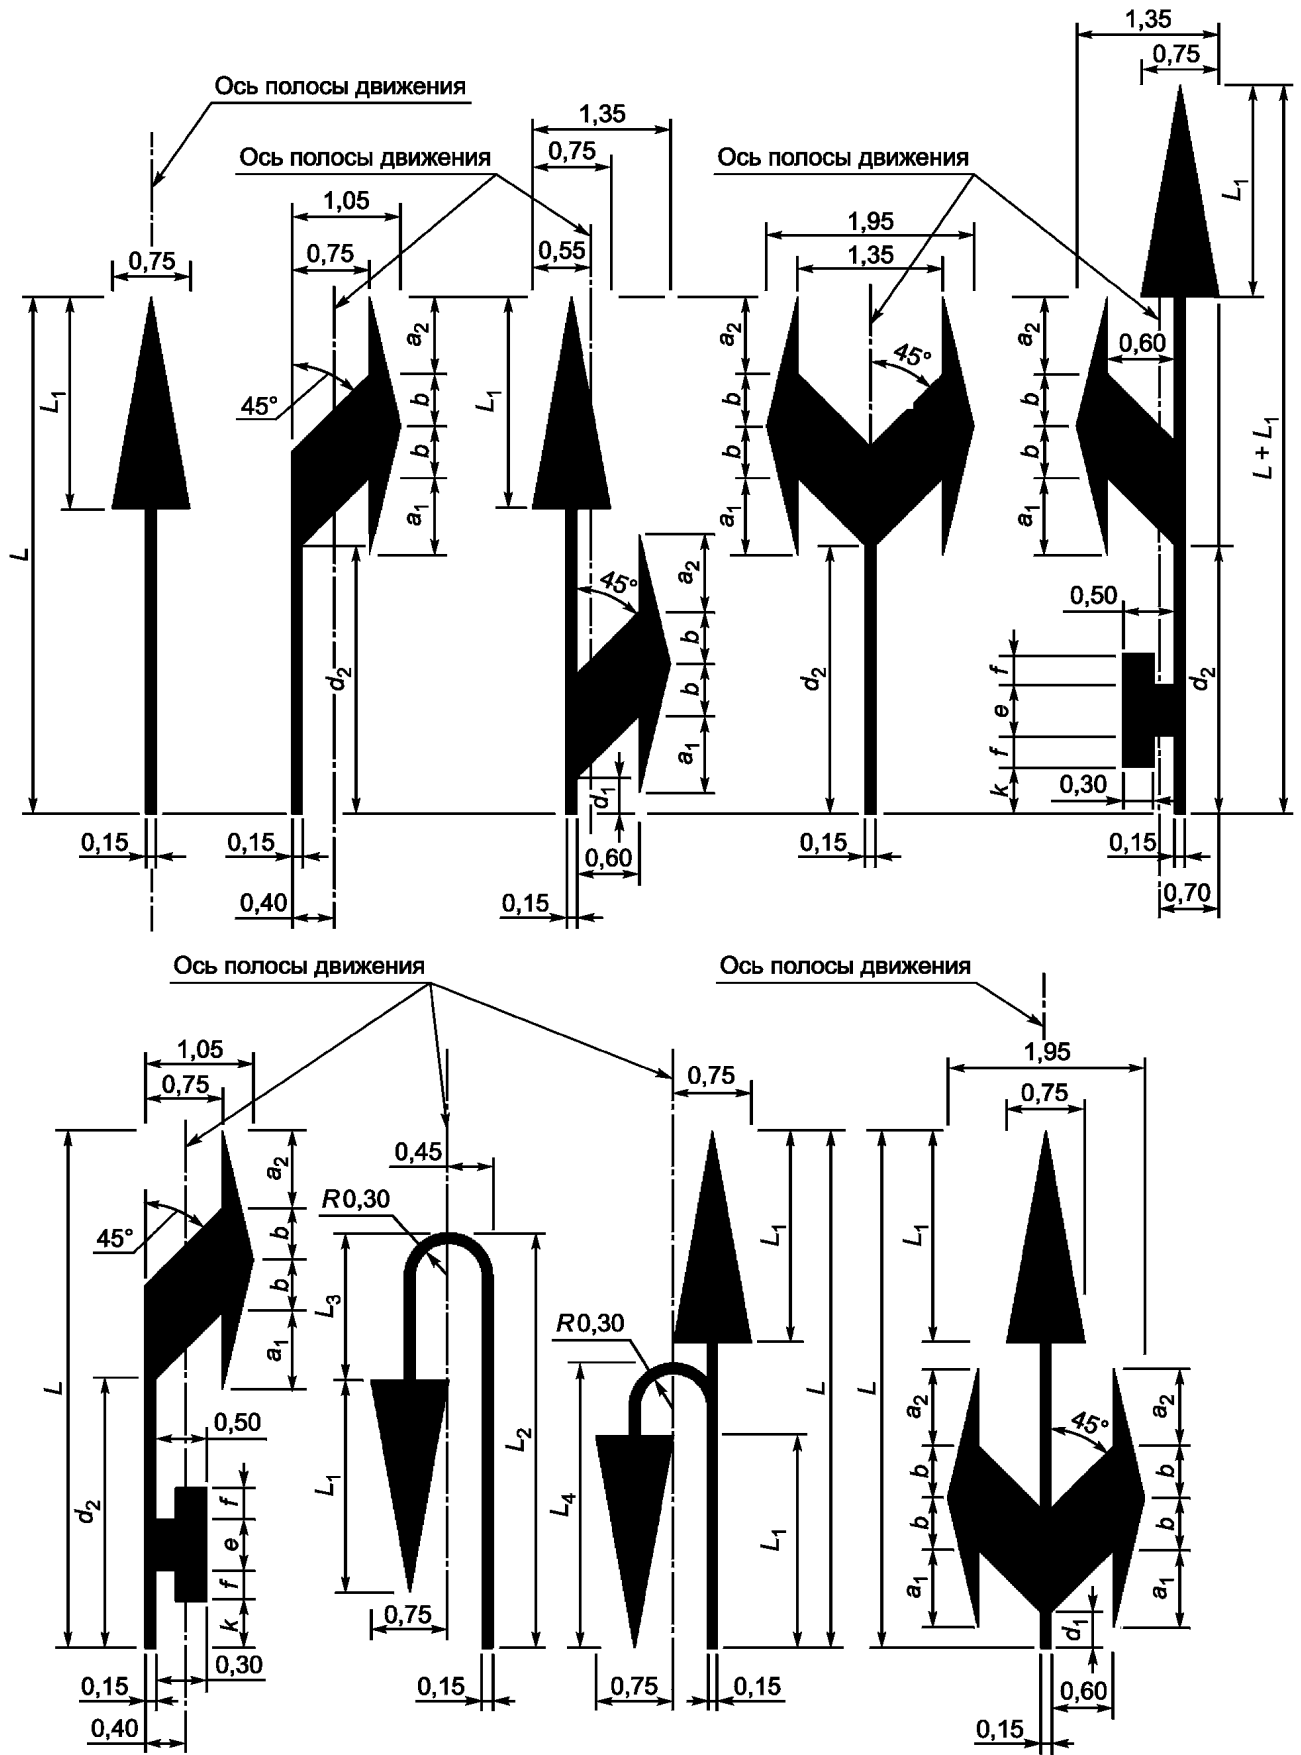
Размеры стрел разметки типа 1.18
